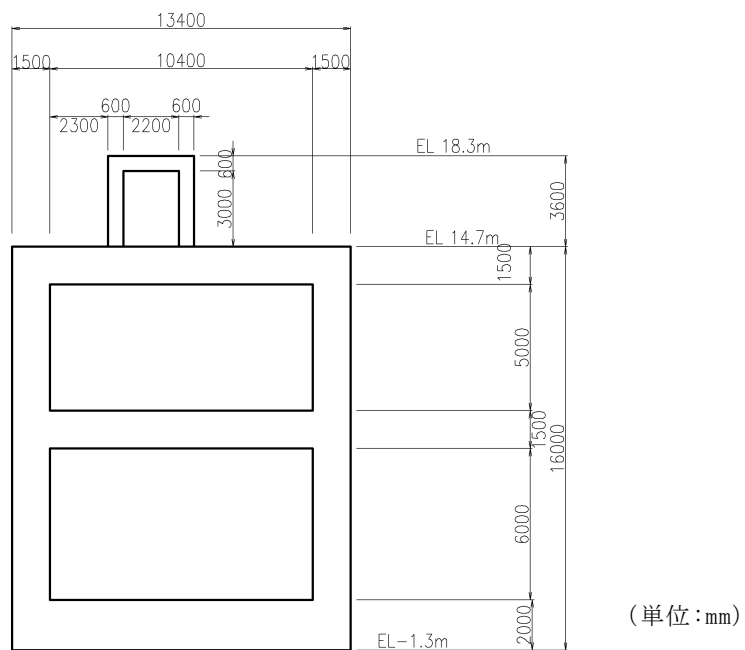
低圧原子炉代替注水ポンプ格納槽 断面図 (A-A 断面)
